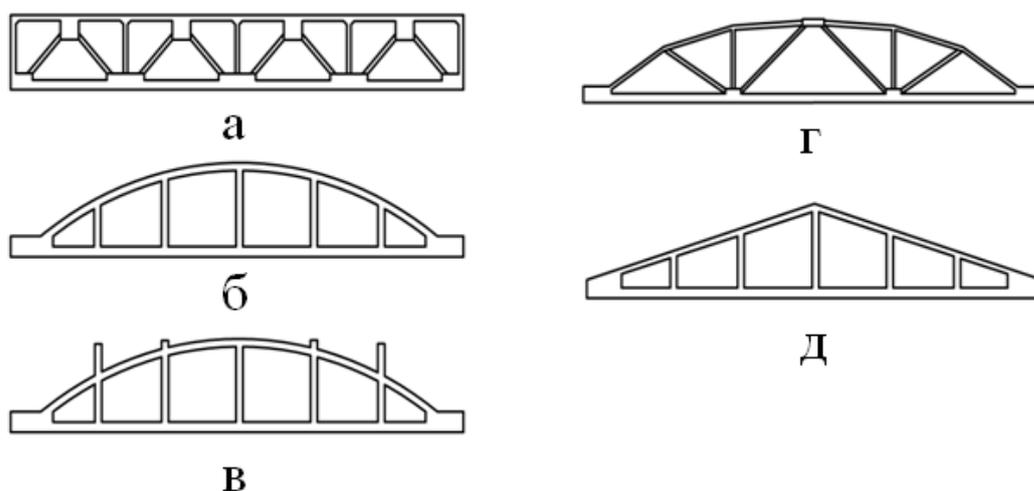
Железобетонные стропильные фермы: а – полигональная; б – безраскосные; в – сегментная; г – безраскосная треугольного очертания
